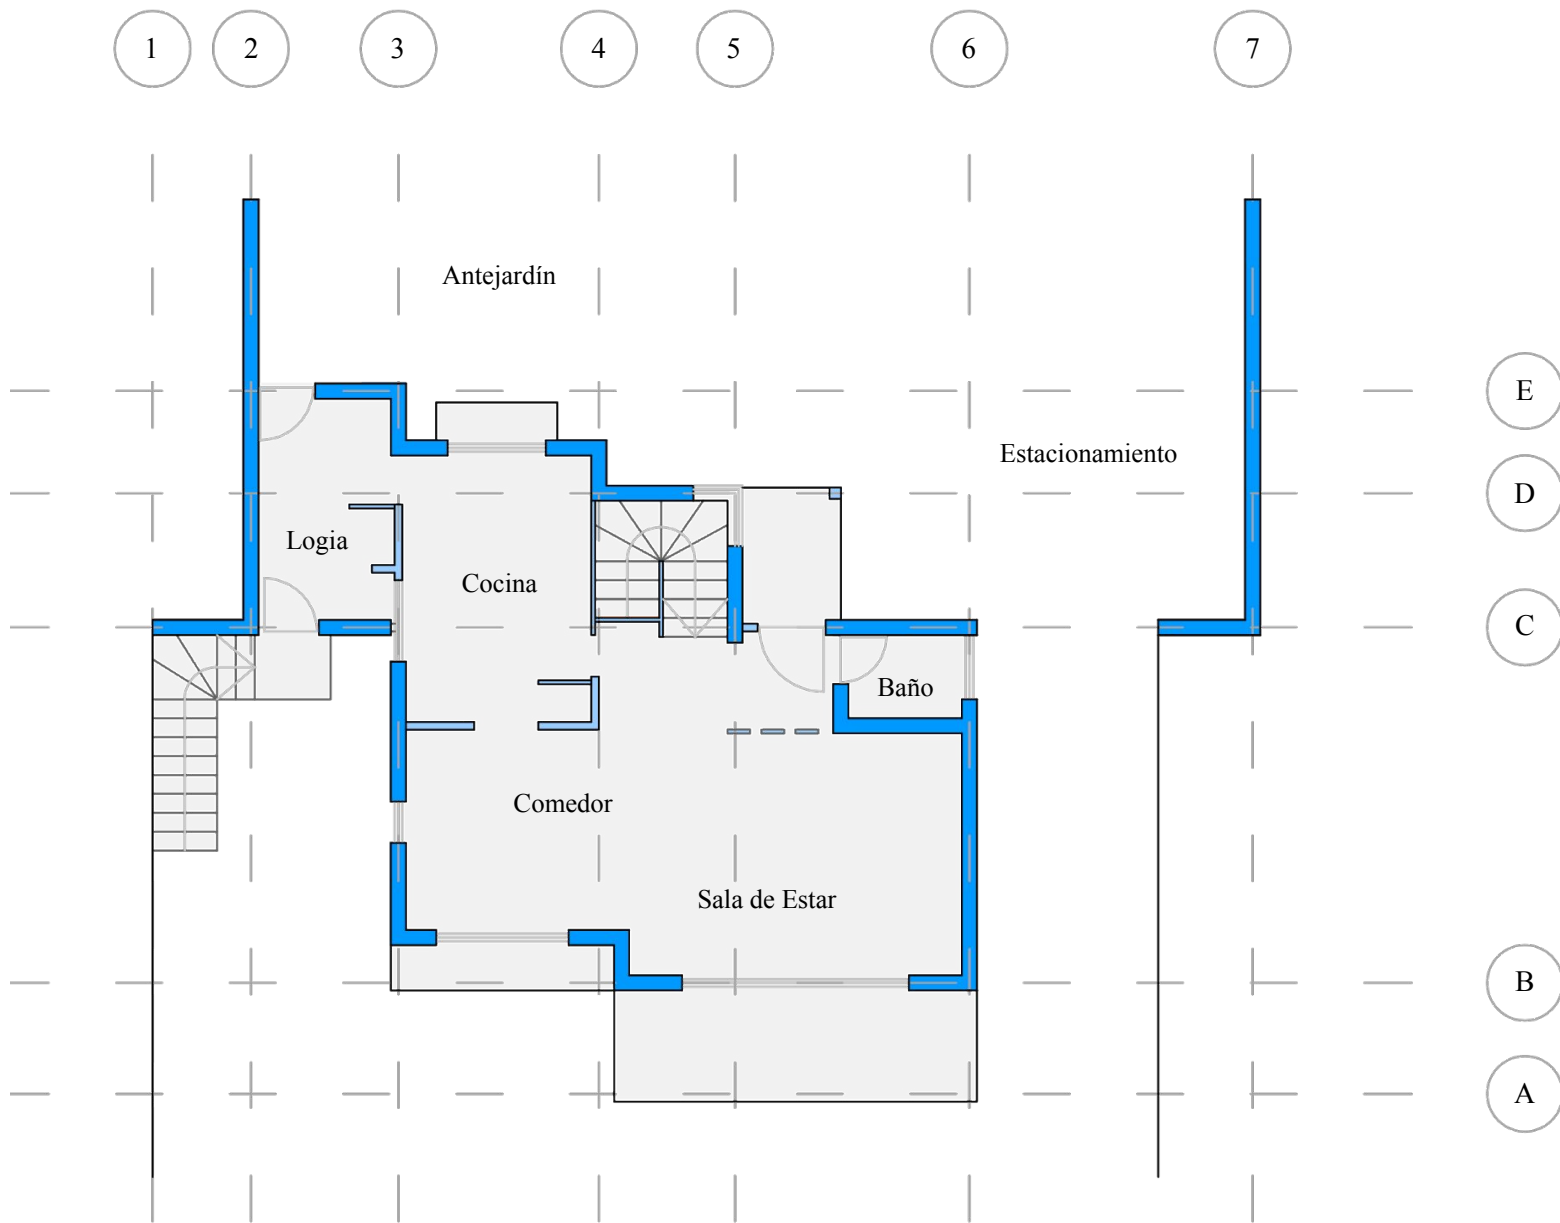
Planta Nivel de Calle en Casa Barrio Alto Mirador (± 0.00)
